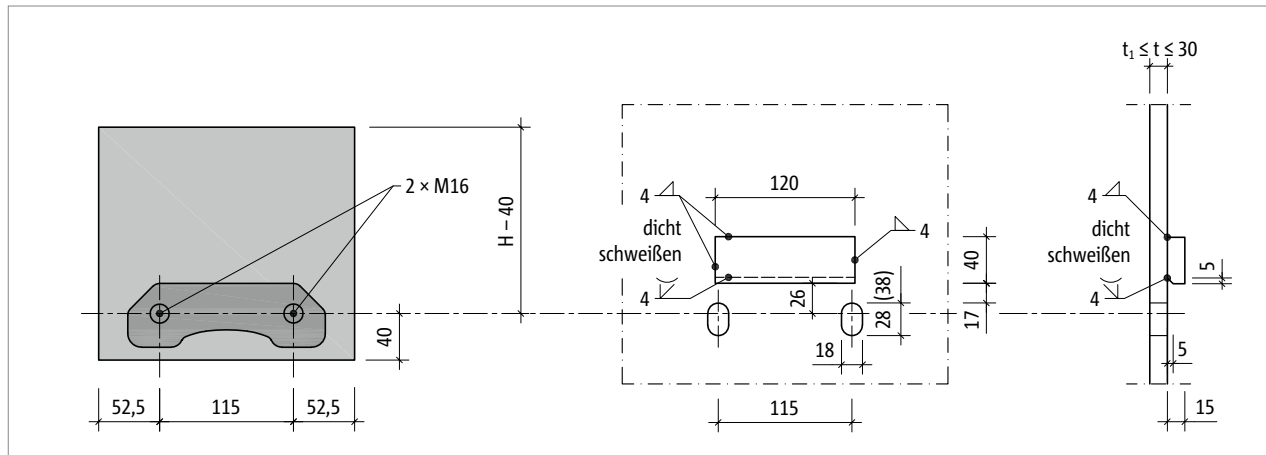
Schöck Isokorb® XT Typ SQP: Konstruktion des Stirnplattenanschlusses
